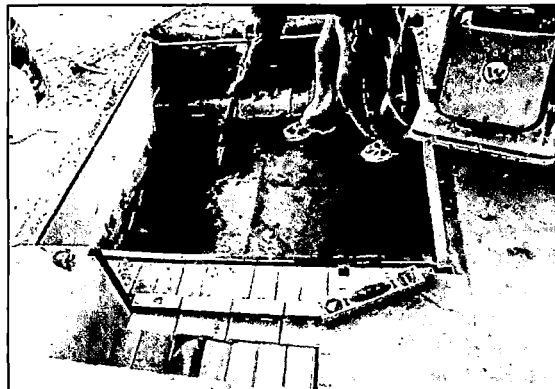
Vista durante la excavación del relleno estructural - Modelo TR
